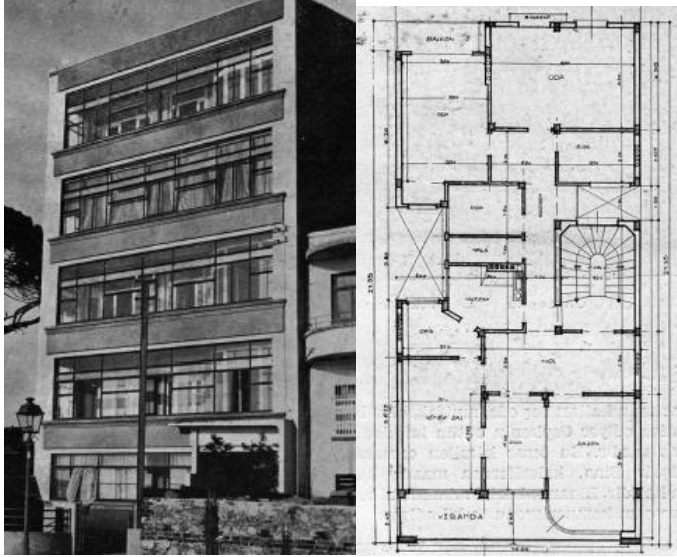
Refik b. Apartmanı görünüş ve planı
